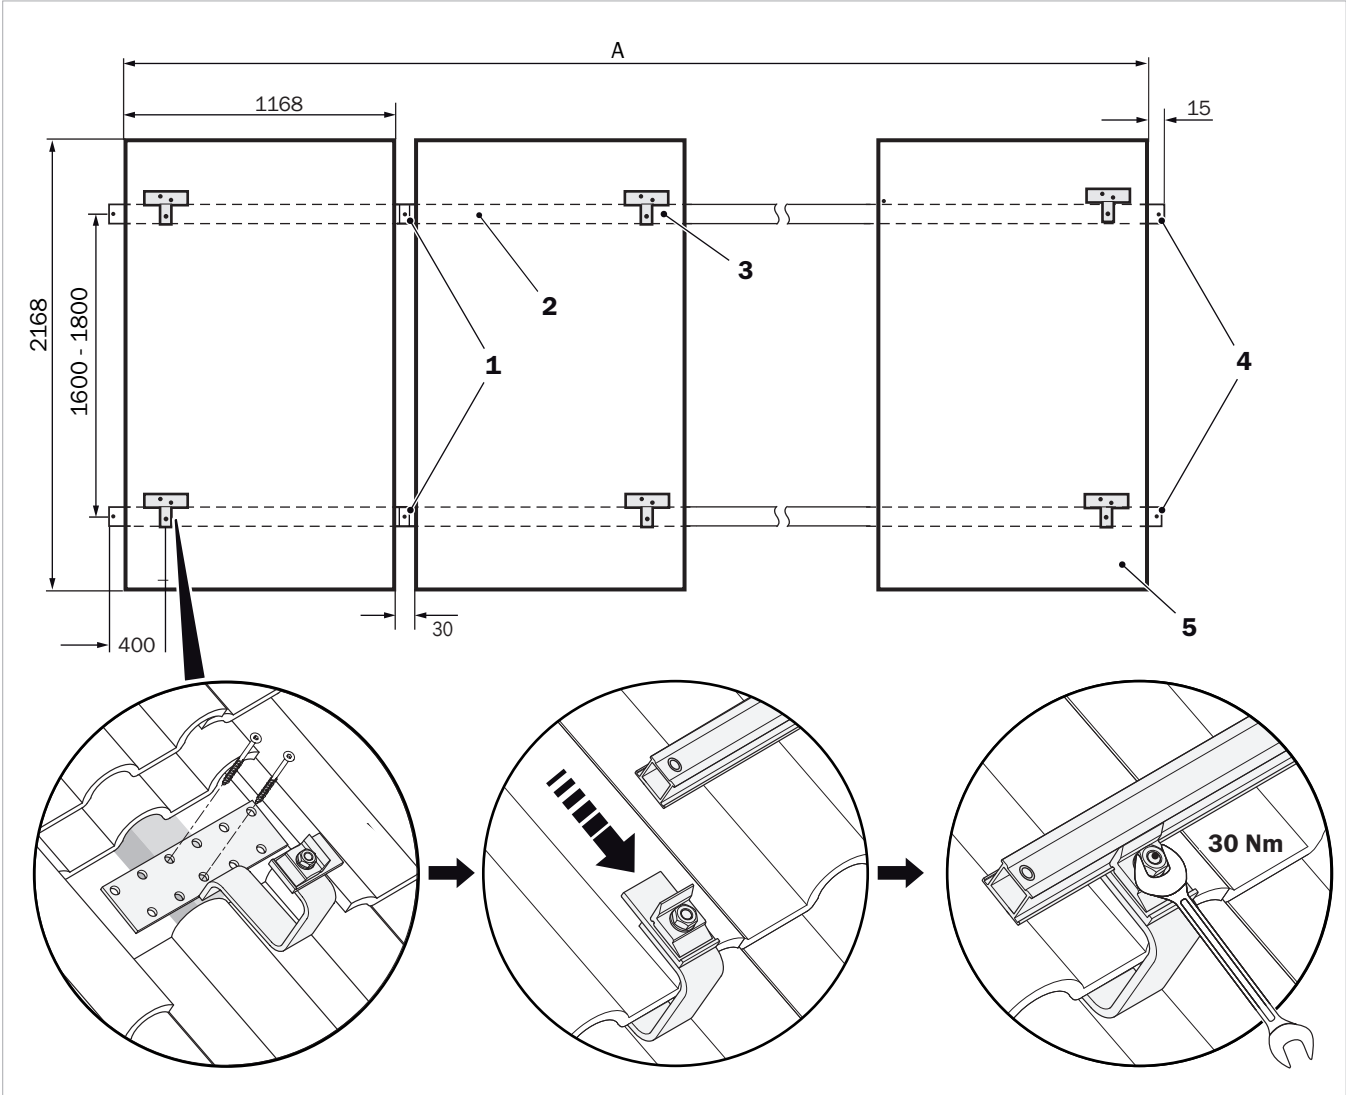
Nebeneinandermontage der Dachhalter und Montageschienen.
